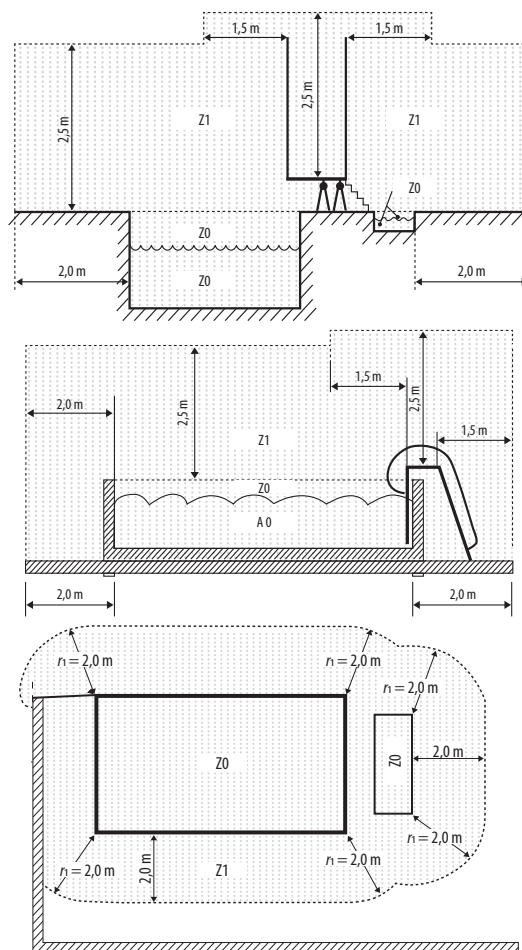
ZONAS DE INSTALAÇÃO Zonas marcadas: a bomba não pode ser instalada aqui
